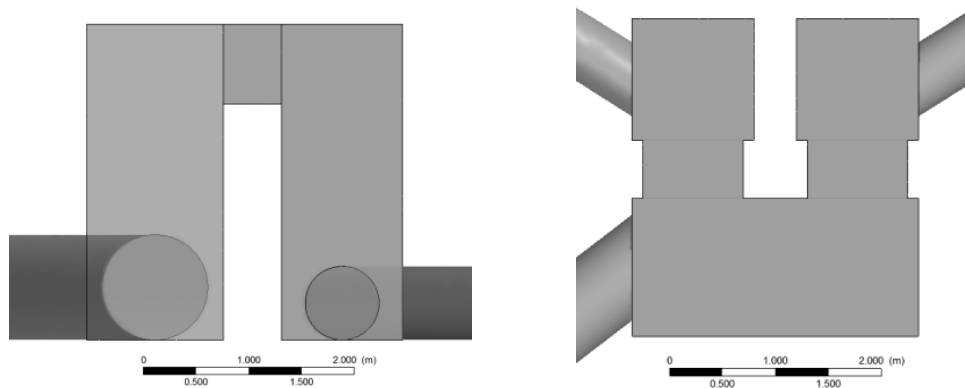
(Bis) Vista de perfil y planta de la arqueta de reparto de entrada a decantación
